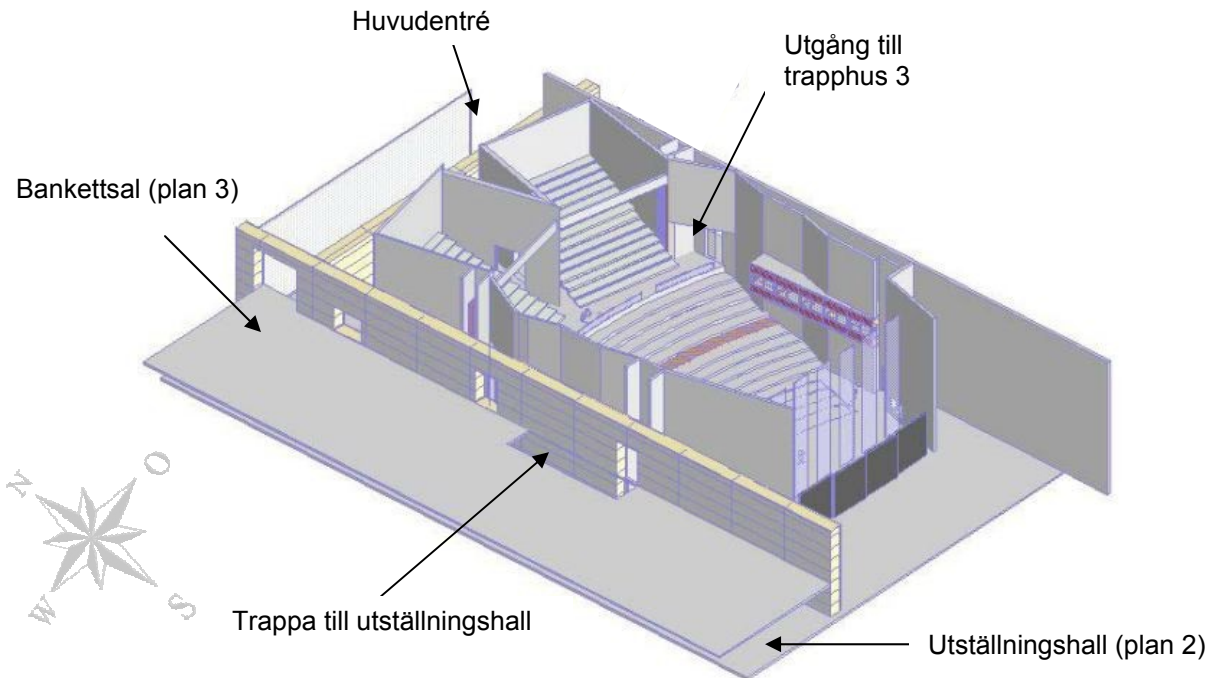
Plan 2 från ovan, norr är åt höger.
